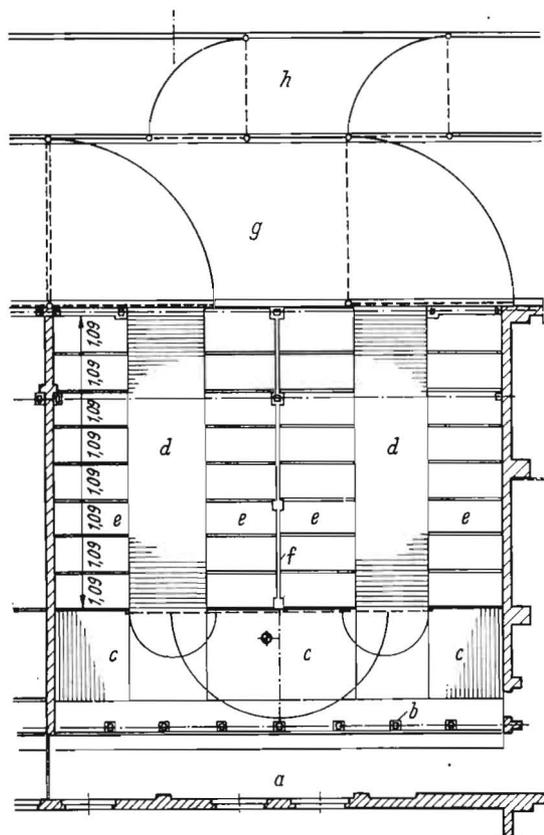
Stallgrundriß nach dem Umbau auf Liegeboxen und Kotrost; a Futtergang, b Absperrung, c Schleppschaufelmal mit Stahlrosten oder Betonrosten abgedeckt, d Lauffläche (Kotkanal ohne Schleppschaufel, mit Rosten abgedeckt), e Boxen (Urengitter aus Gasrohr mit 25 mm  $\varnothing$ ), f Abtrennung mit Bohlen, g Auslaufflächen, h Trift
